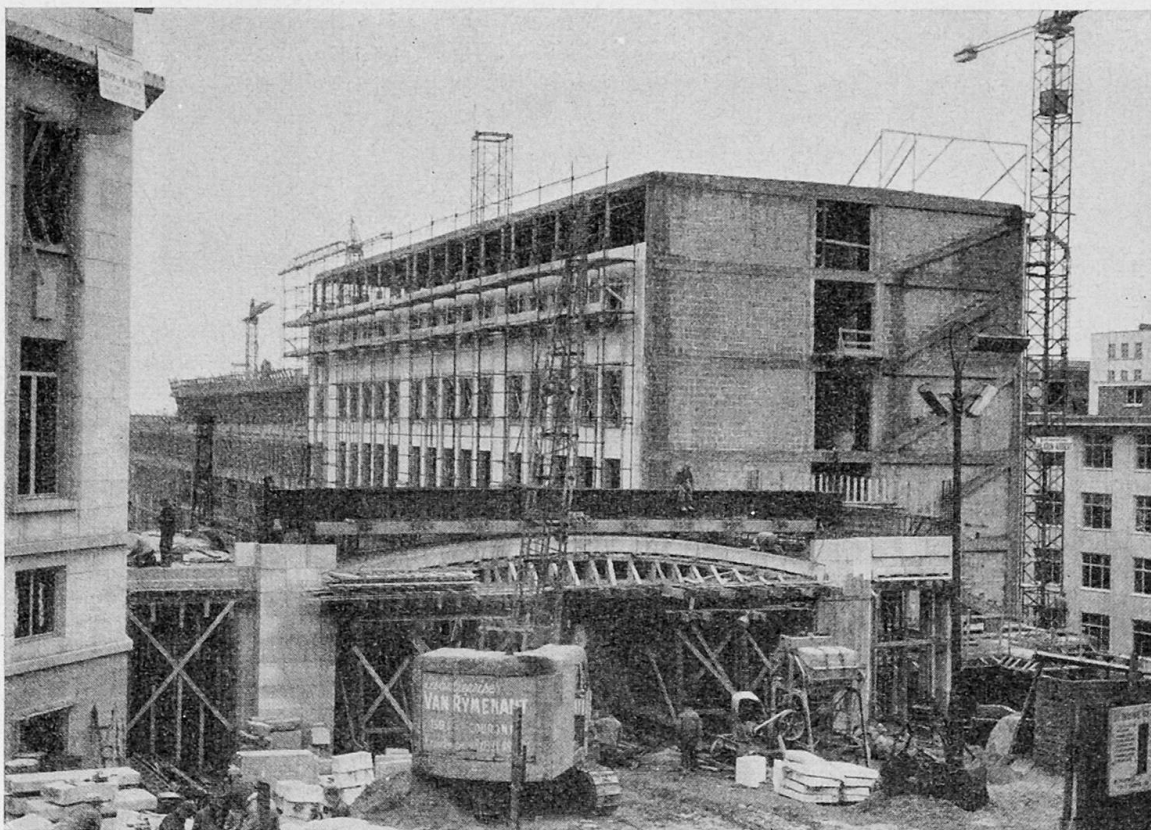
Complexe du Mont des Arts à Bruxelles. Une des deux poutres supportant le bâtiment qui surplombe la rue Montagne de la Cour. La voûte en pierres de France est suspendue à la poutre Préflex.
